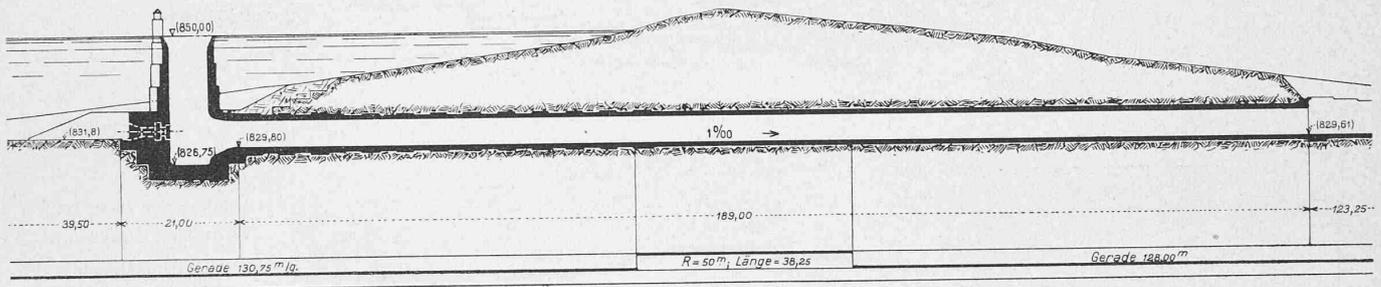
Längsschnitt durch Grundablass und Ueberlaufsturm und den Ablaufstunnel nach dem Löntsch. — Masstab 1 : 1200.
